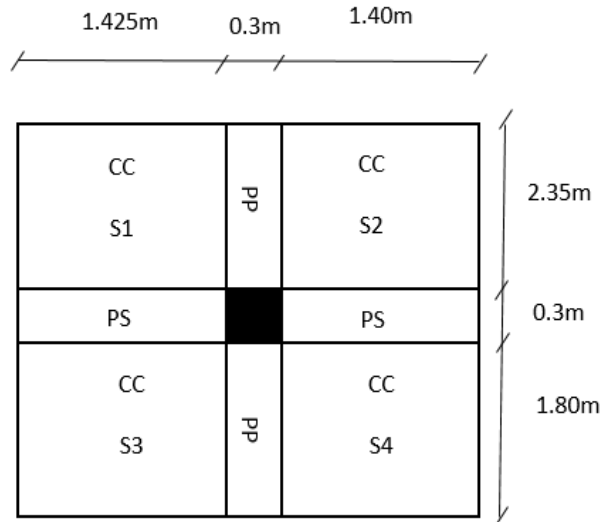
Surface afférente au niveau du plancher de RDC, 1er, 2^{ème} étage
